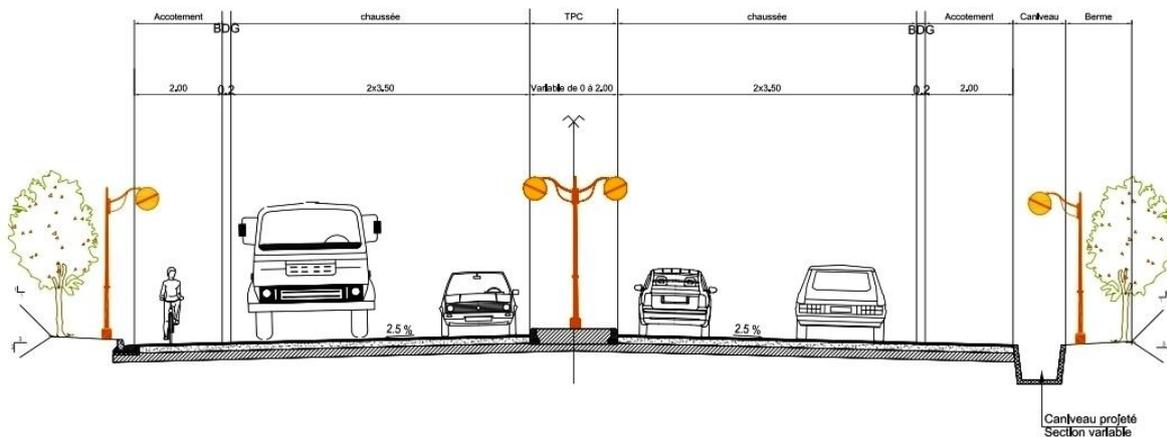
Proposition d'aménagement de la traversée des agglomérations (variante 2)
